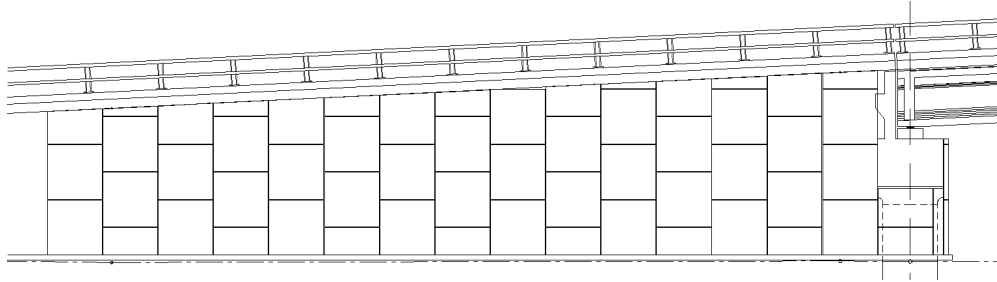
Vista de elevación de accesos de proyecto.
